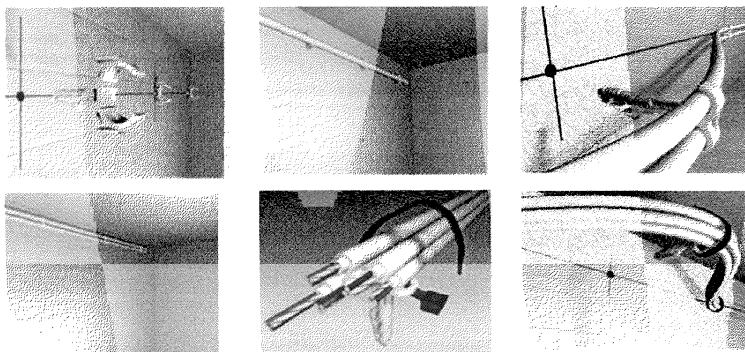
Вариант монтажа открытой электропроводки с помощью дюбелей, клипс и бандажных полосок
